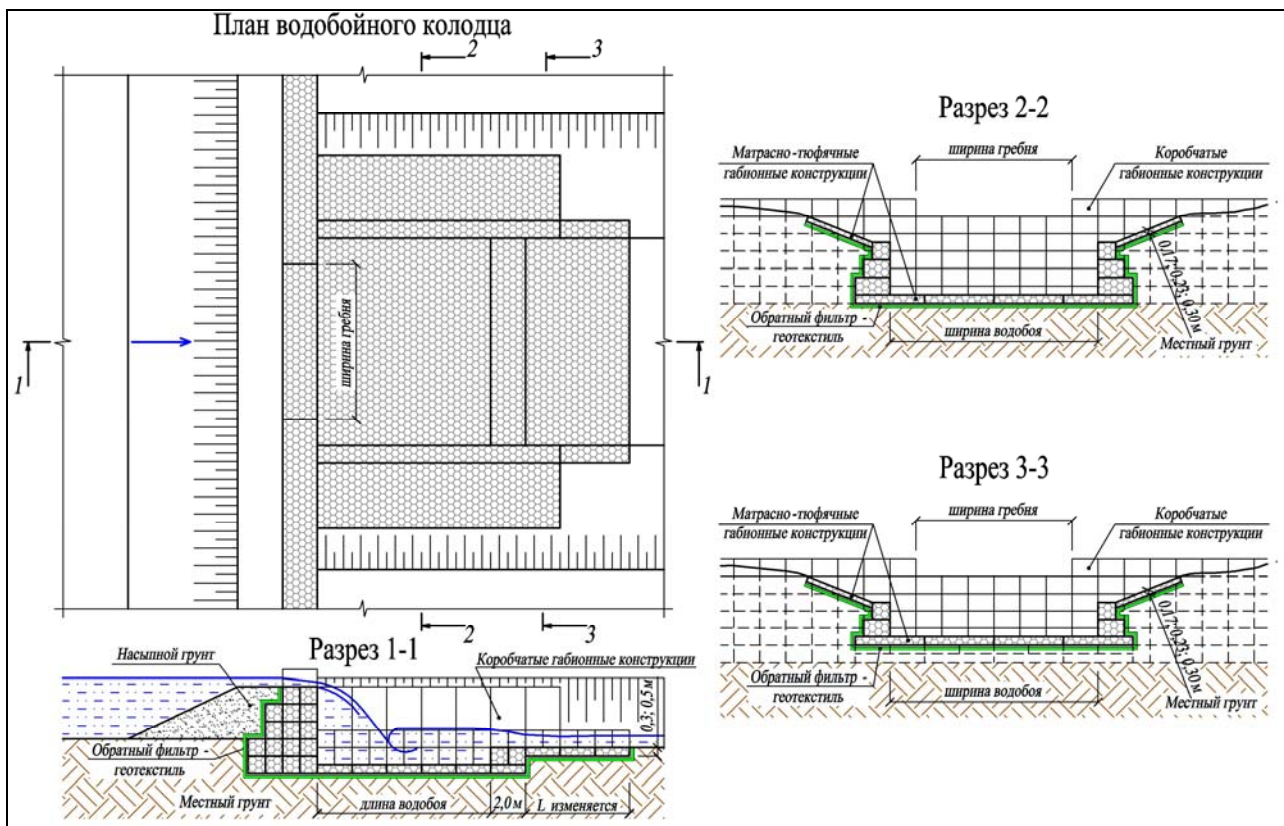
Водобойное устройство из габрионных конструкций (вариант 3)
